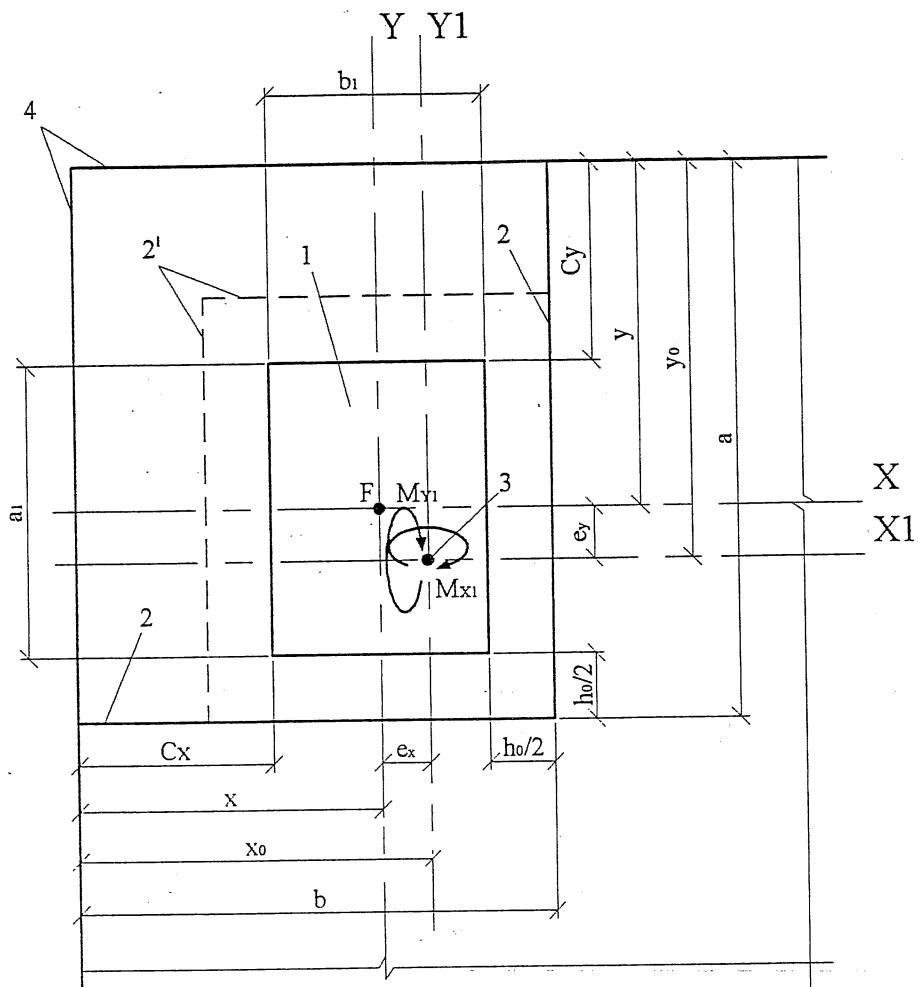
Схема для расчета железобетонной плиты на продавливание при расположении колонны у угла плиты
